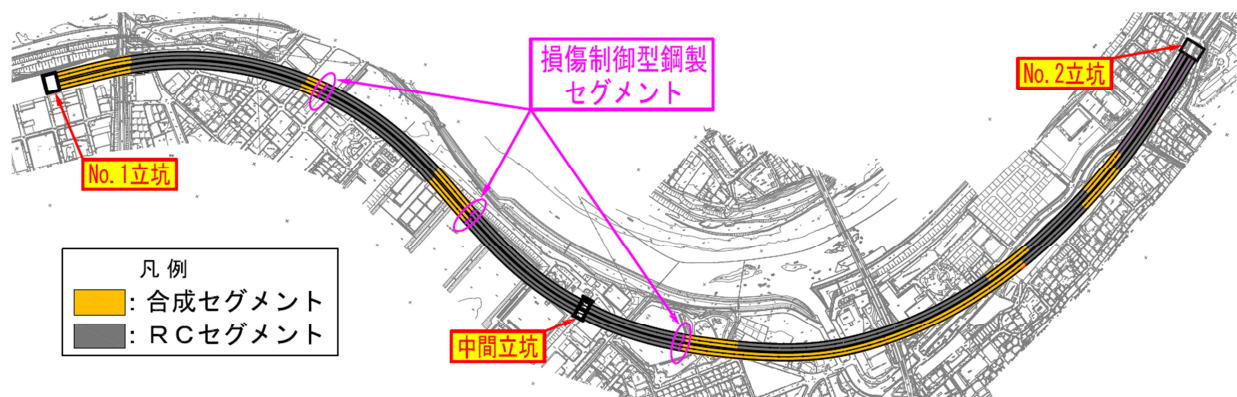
大和川線シールドトンネル（阪神高速道路(株)施工区間）平面図
